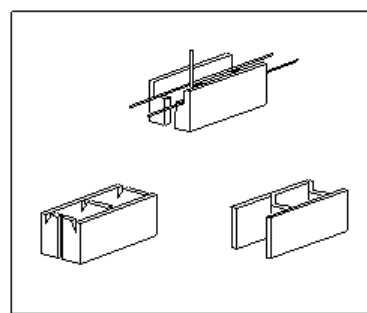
Blocchi con apposita sede per armatura orizzontale (3)
